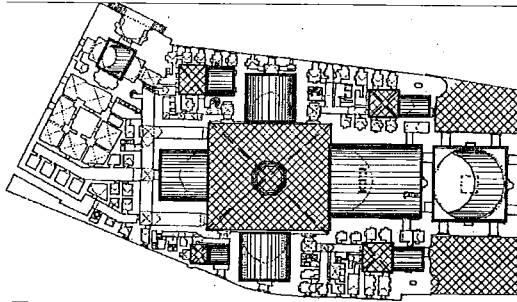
مسقط أفقي مدرسة السلطان حسن
